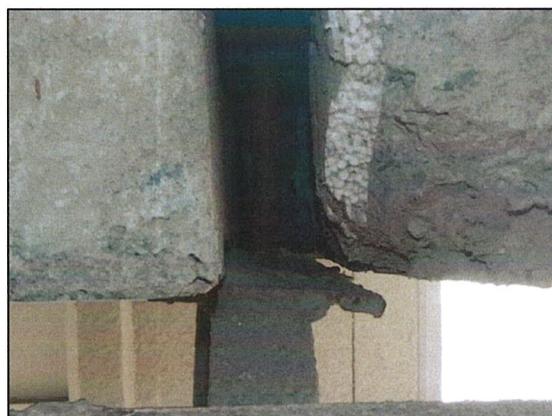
, espárragos de amarre entre la escalera y la losa sin afianzar.
